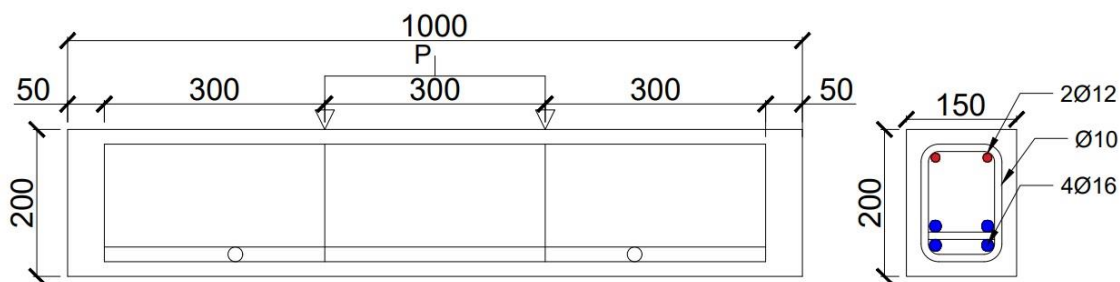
Размеры и детали внутреннего армирования железобетонных балок
